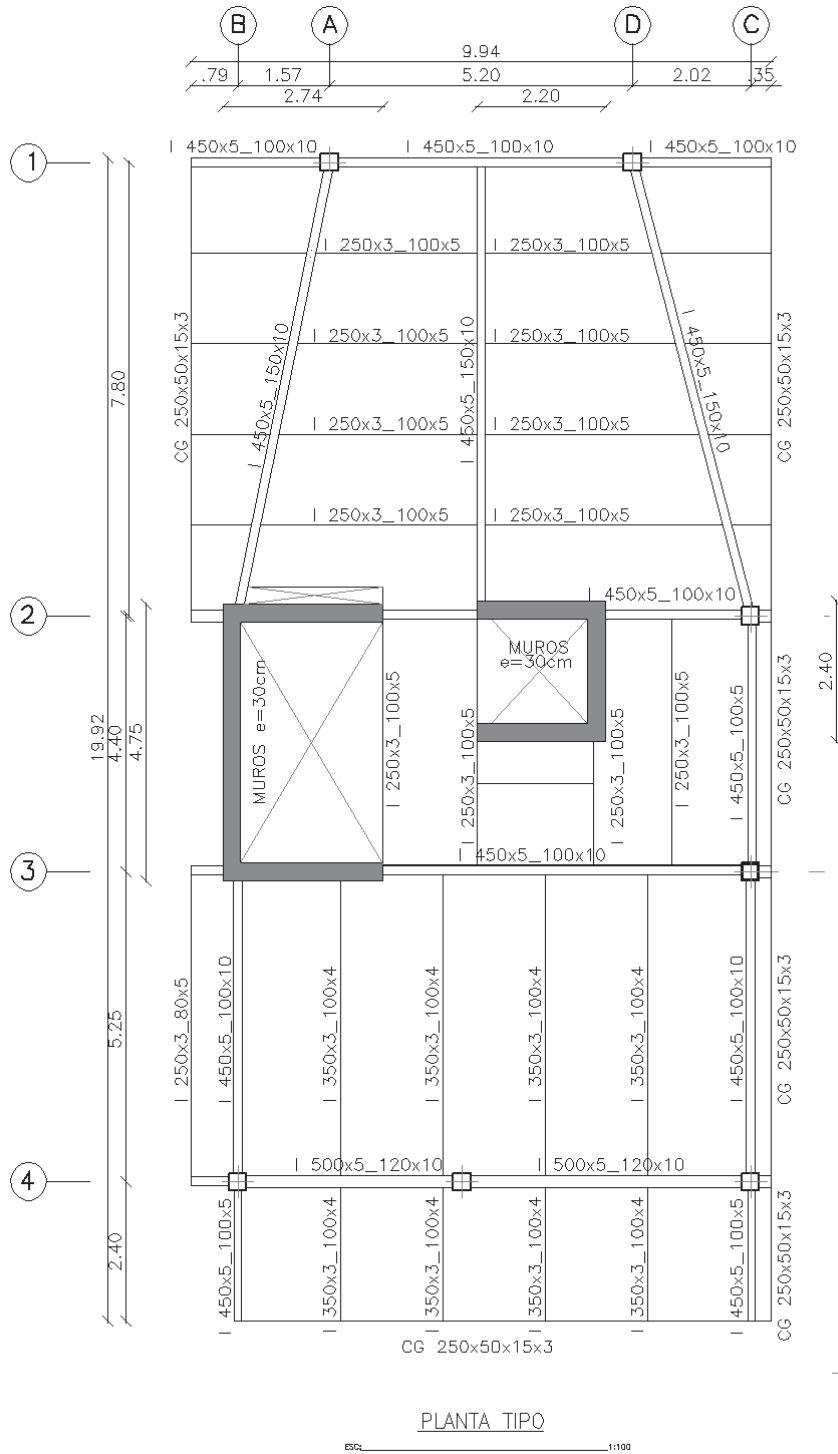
PLANTA ESTRUCTURAL TIPO JADE
